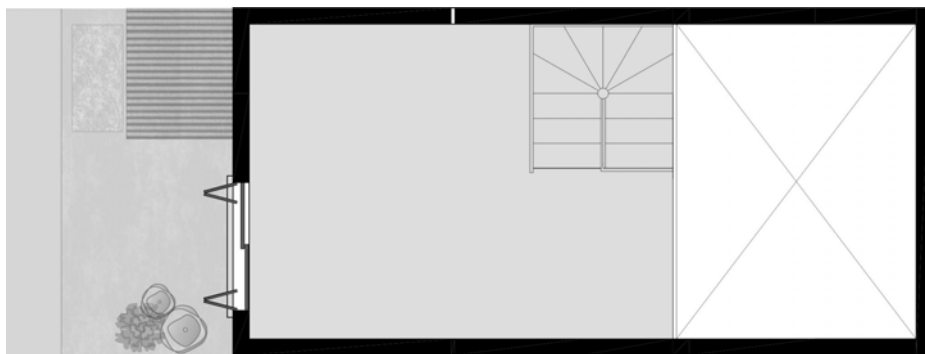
Planta do Terceiro Pavimento do Sobrado - UH009 (sótão)
